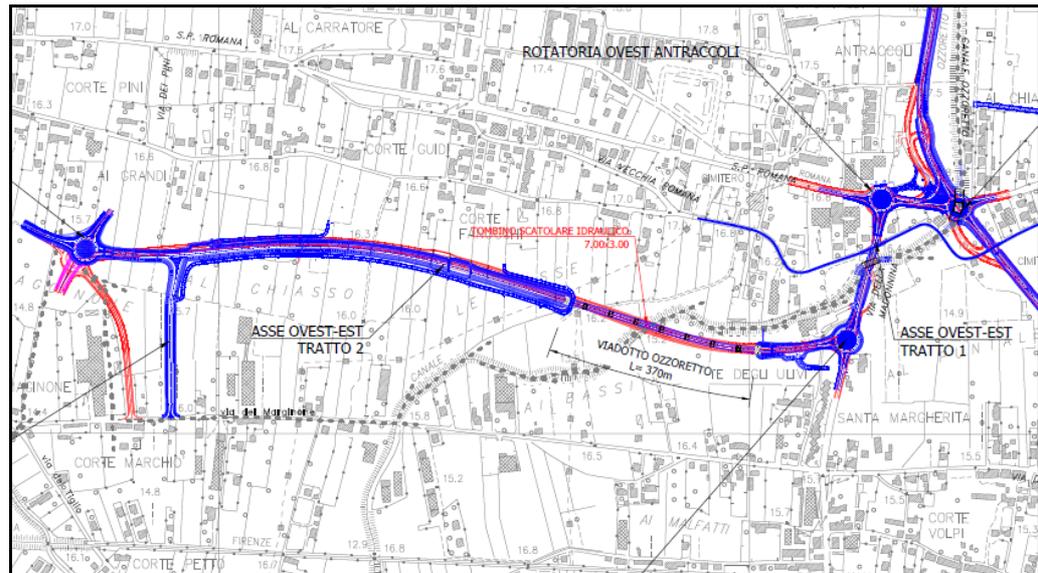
Planimetria di confronto PP (rosso) - PD (blu) - Asse Ovest-Est
